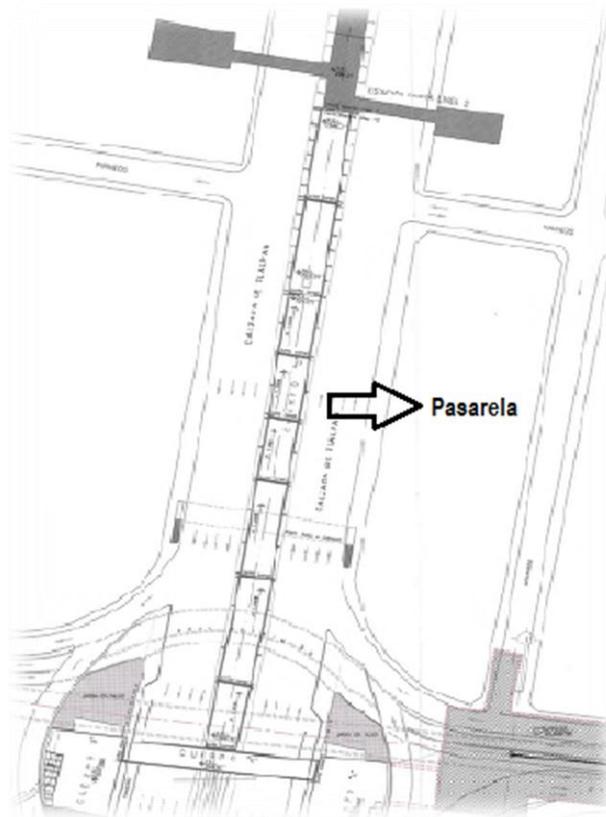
Planta de Conjunto arquitectónico. Pasarela
